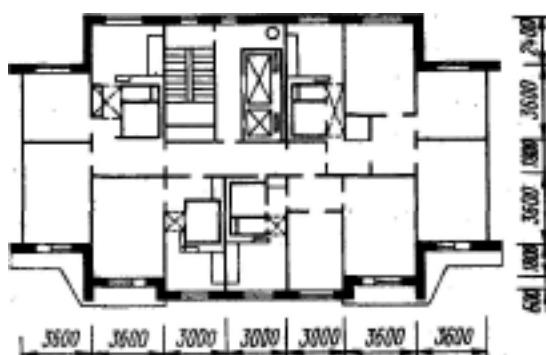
Крупнопанельный 16—17-этажный дом серии П-44 (план секции)
